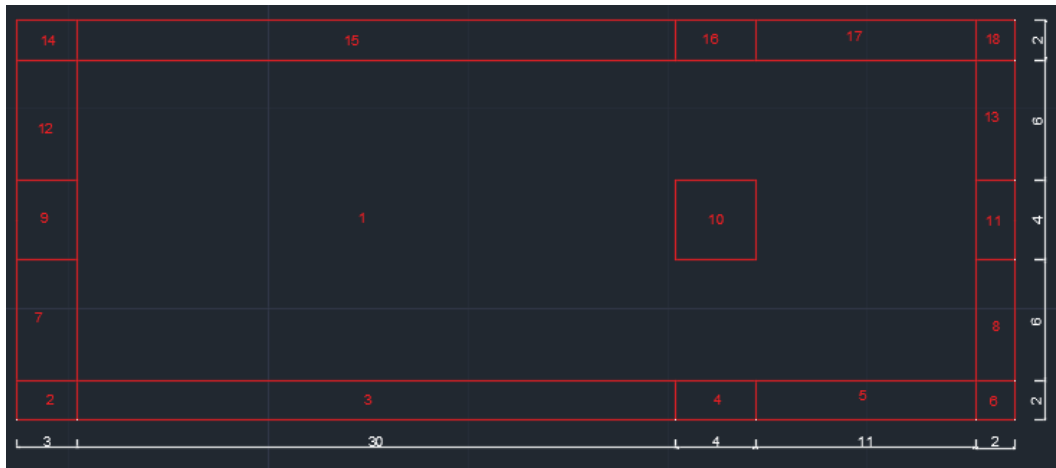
18. Numeración de zonas de armado (rojo) de la losa.
